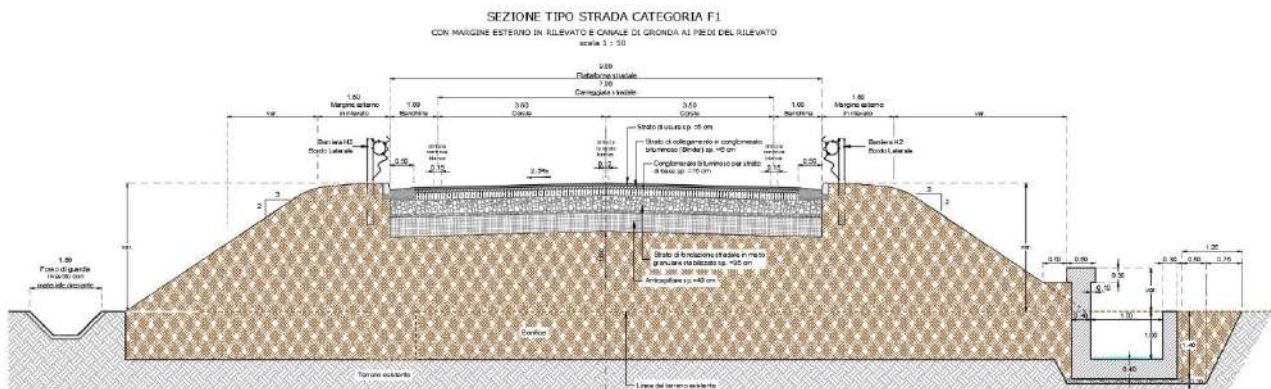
Sezione tipologica con margine esterno in rilevato e canale di gronda ai piedi del rilevato
